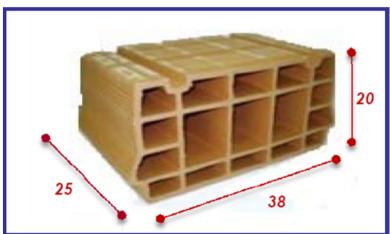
Sezione tipo solaio laterocemento soggetto a sfondellamento
